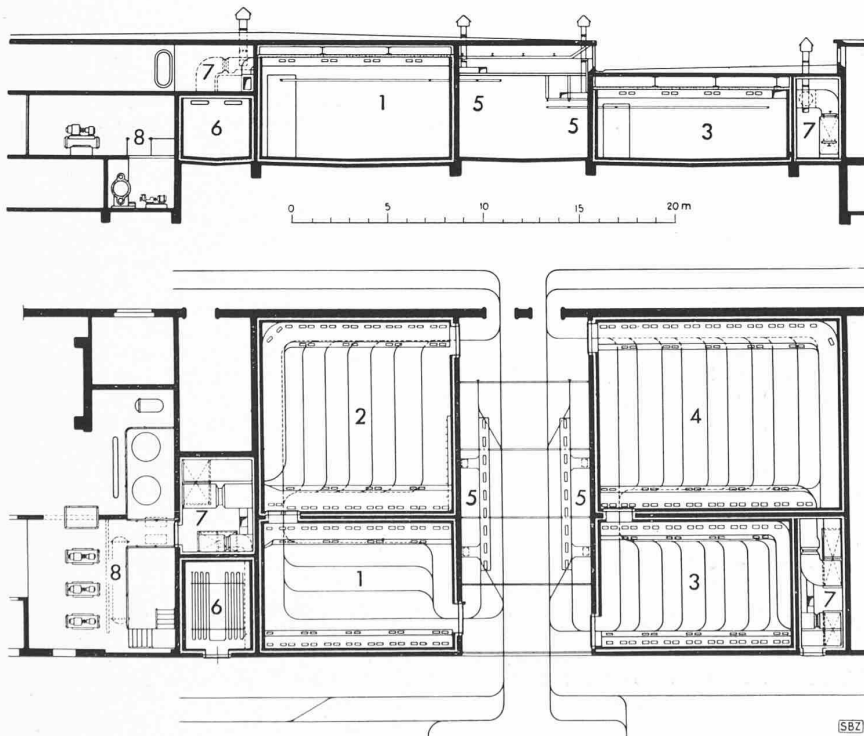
Grundriss und Schnitt vom Kühlhaus des Schlachthofs Winterthur. — Masstab 1 : 350
